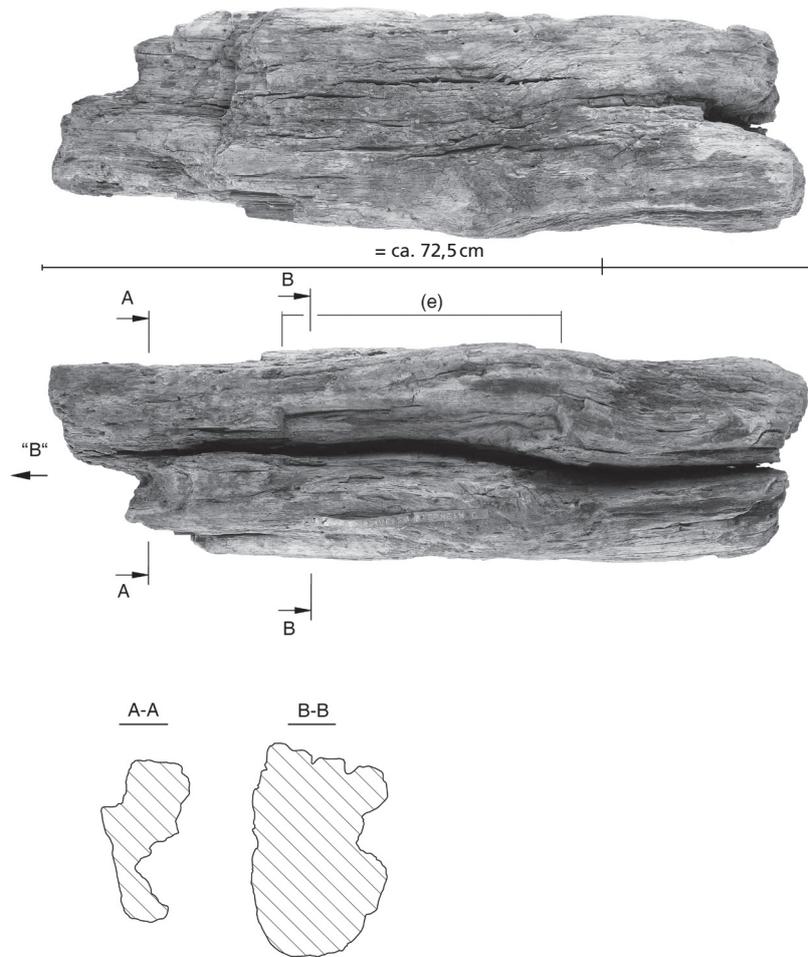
Schwellbalken einer Fachwerkkonstruktion. Bruchstück C.
